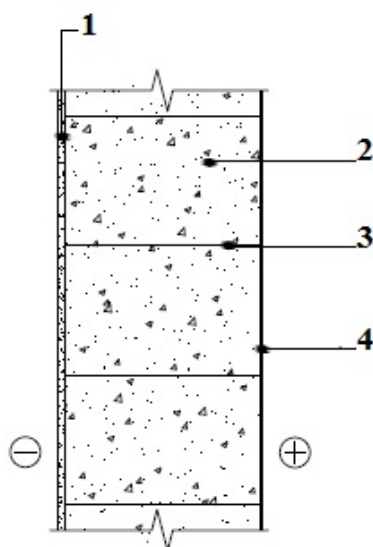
Стеновой блок со штукатуркой: 1 — наружная паропроницаемая штукатурка; 2 — блоки YTONG; 3 — раствор для тонкошовной кладки; 4 — внутренняя отделка
